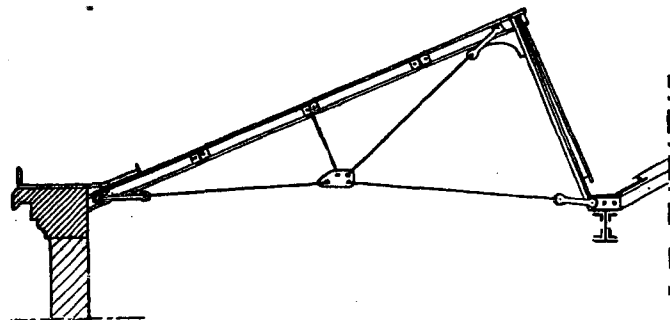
Armadura articulada, en diente de sierra, tipo Polonceau.
